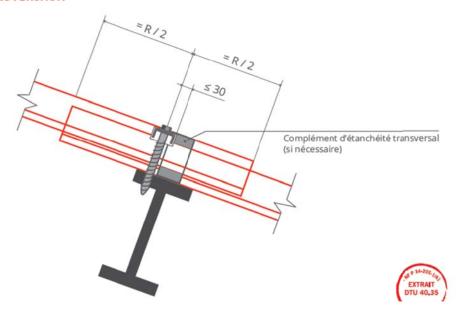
Complément d'étanchéité - Pose avec fixations en plage
